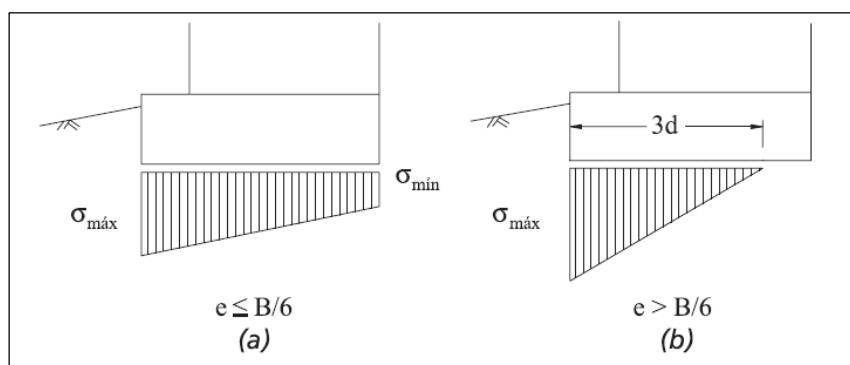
Tensões aplicadas à fundação (Barros, 2021)
